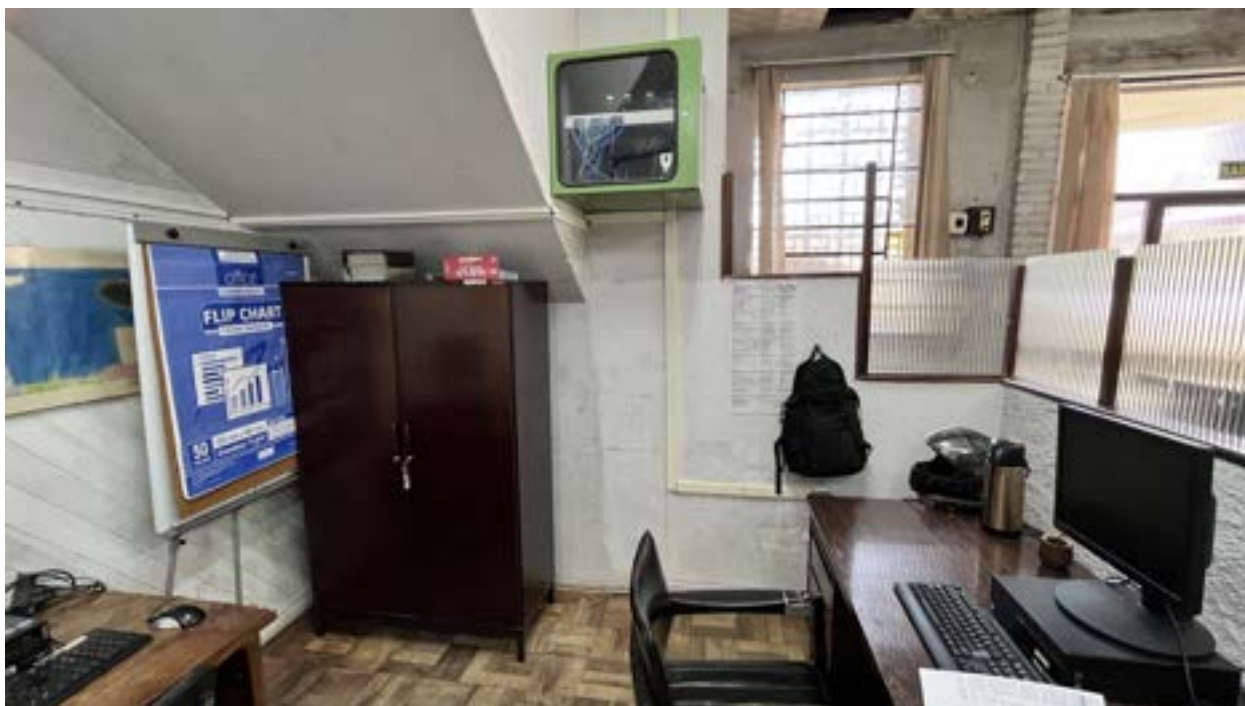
SUBÁREA B – Visão aproximada das canaletas da parede do rack (R)
